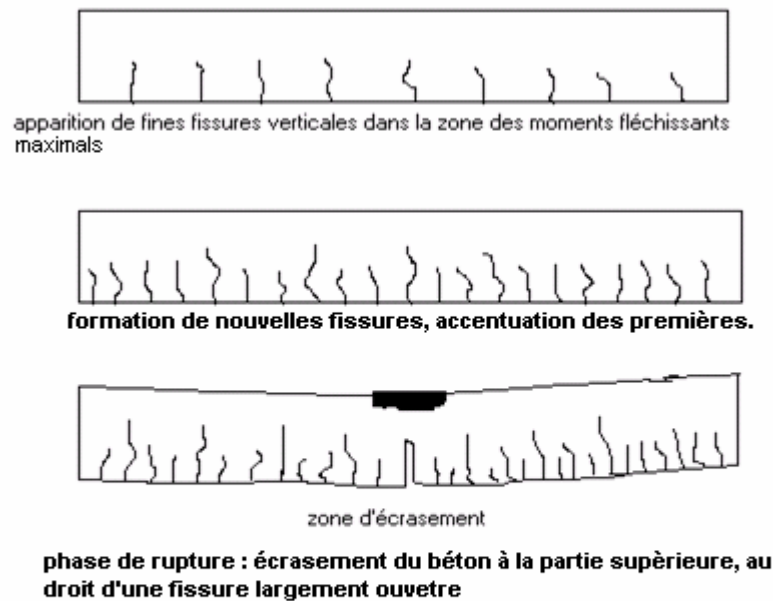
Processus du développement de la fissuration et de la ruine d'une poutre soumise à la flexion simple [17].
